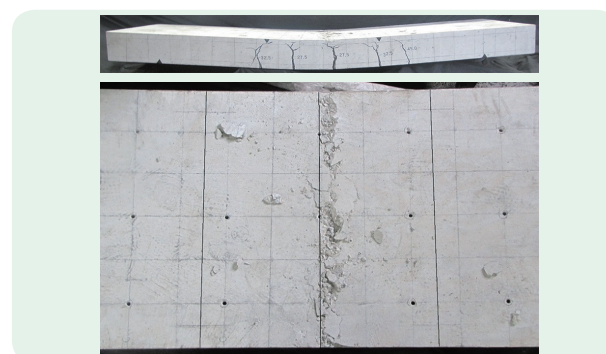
ビス穴 @ 200mm 試験体の破壊状況 (上:側面 下:平面)
